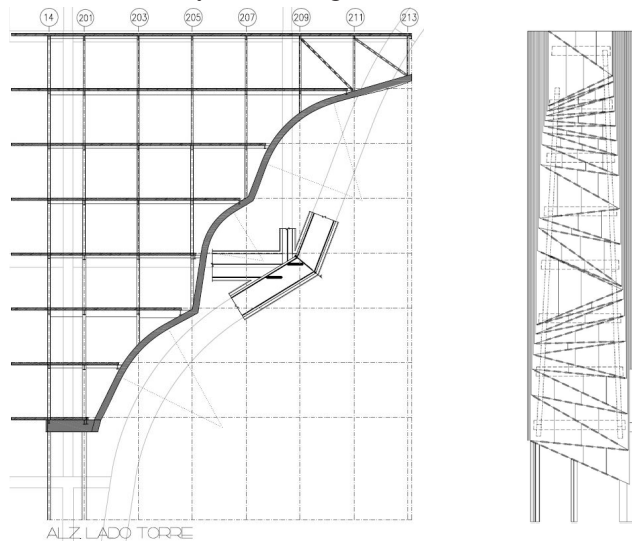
Edificio 'Capitel'. Alzados constructivos.
